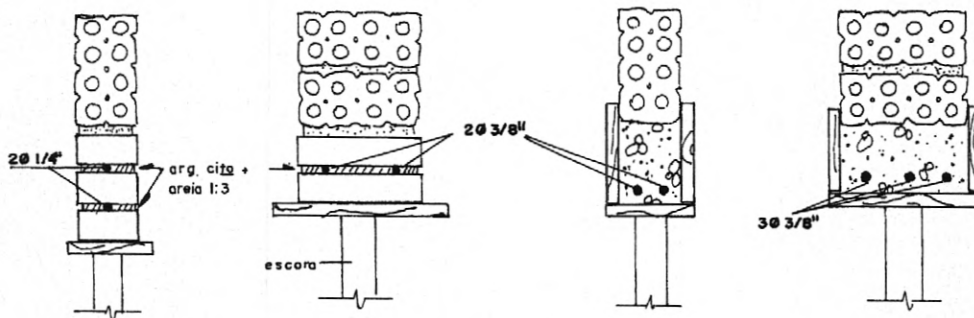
Vergas em alvenaria de tijolo furado para vãos até 1,00m e entre 1,00m e 2,00m
